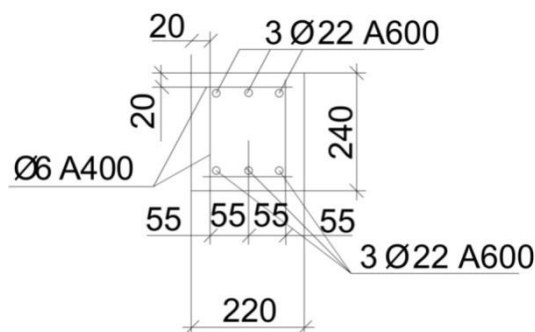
Размещение продольной напрягаемой арматуры
